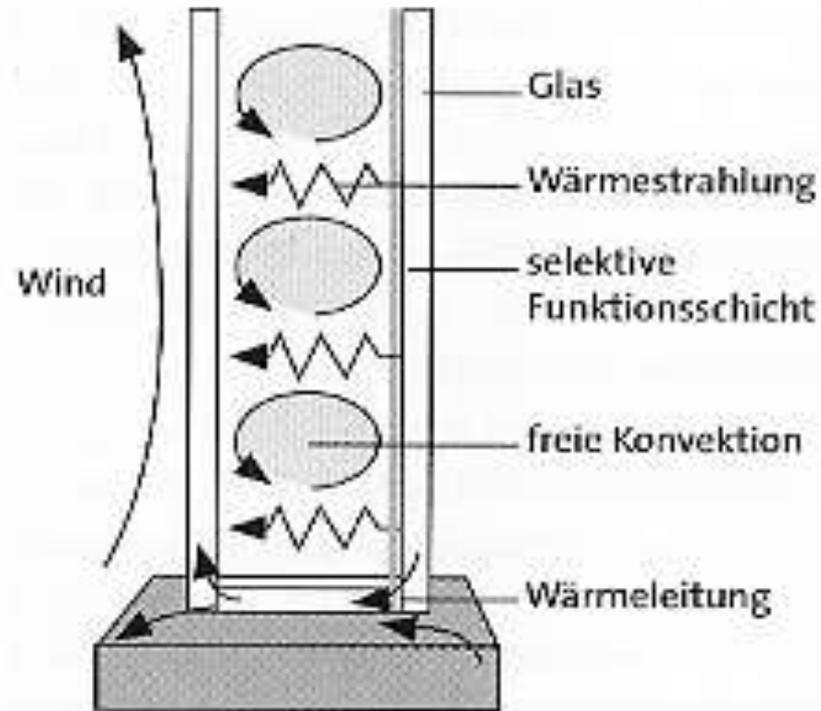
Wärmetransportmechanismen in einer Doppelverglasung
